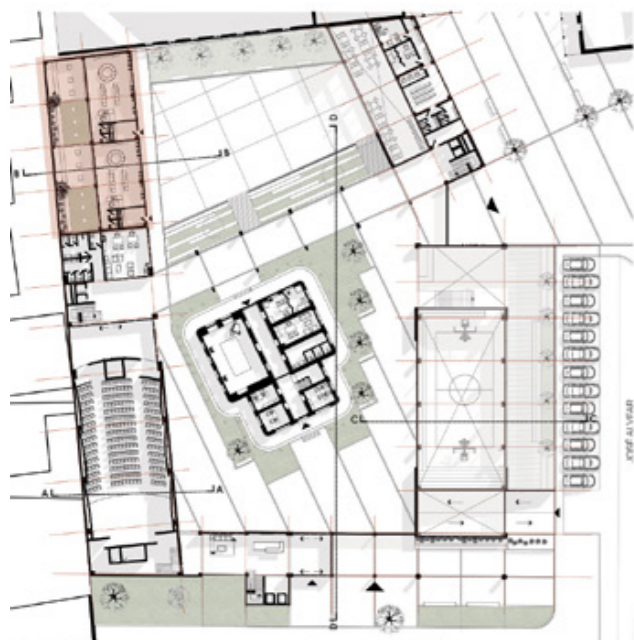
Esquema Planta baja | Fuente: Elaboración propia
